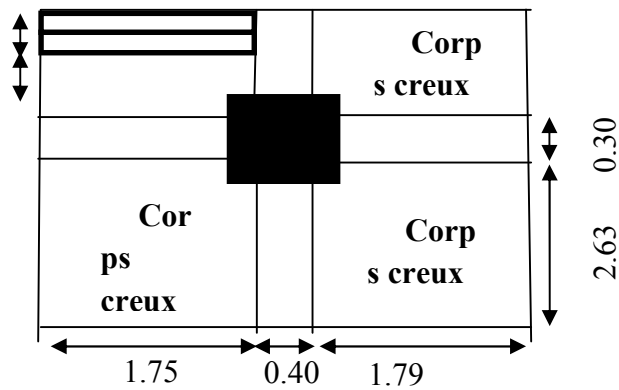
Schéma de la surface afférente de Poteau « B ».
